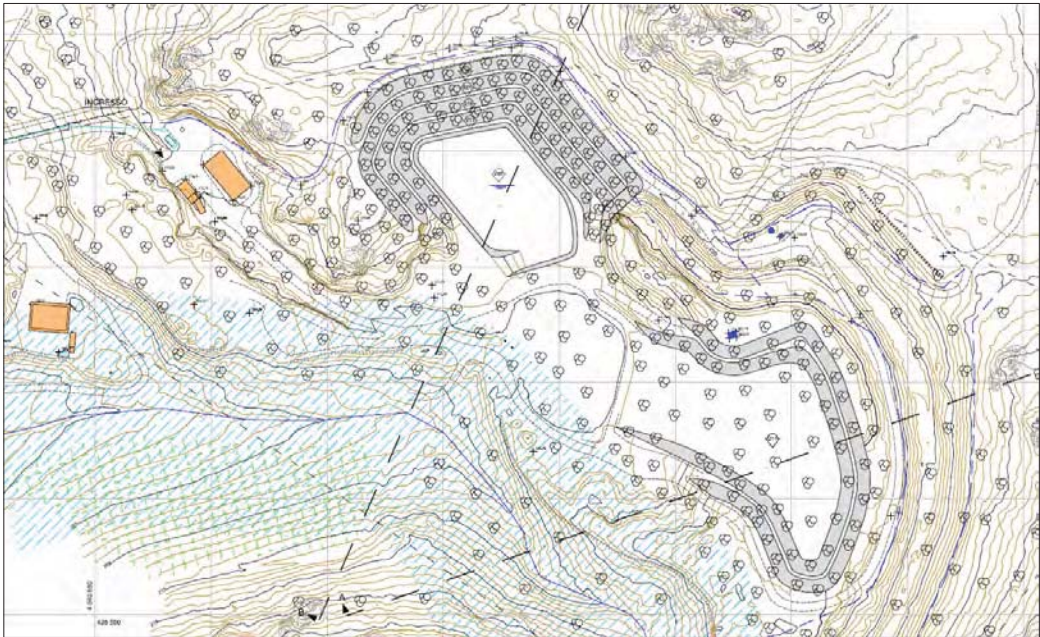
/A – Planimetria del sito allo stato finale con il ripristino
